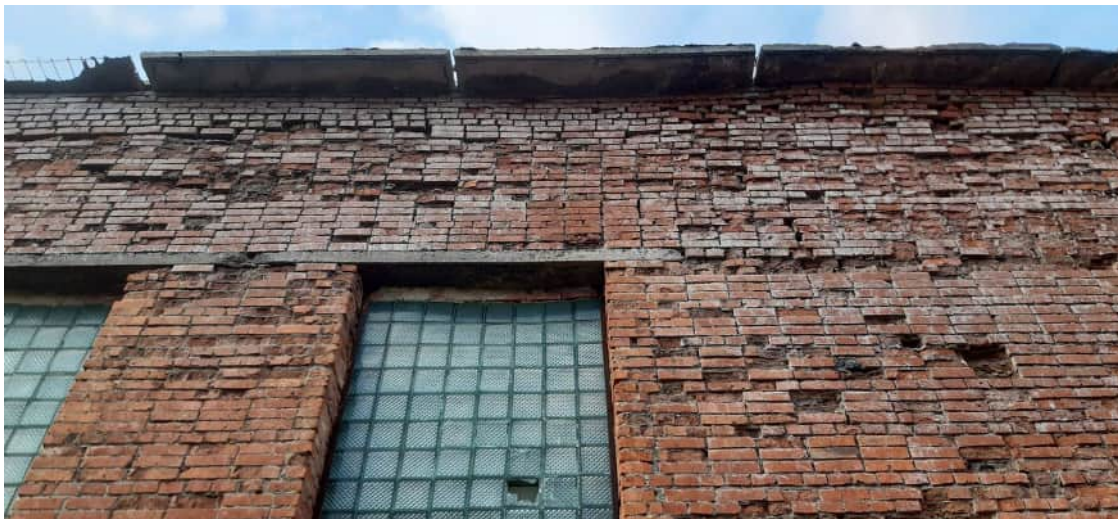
Разрушение наружной версты кирпичной кладки на глубину до 100мм
